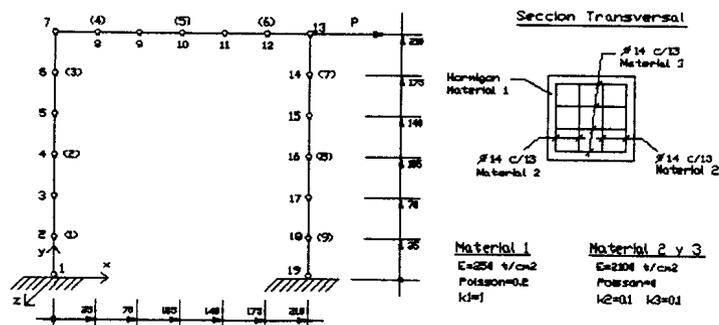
Discretización un pórtico de hormigón armado confinado en estado tensional de barras.
